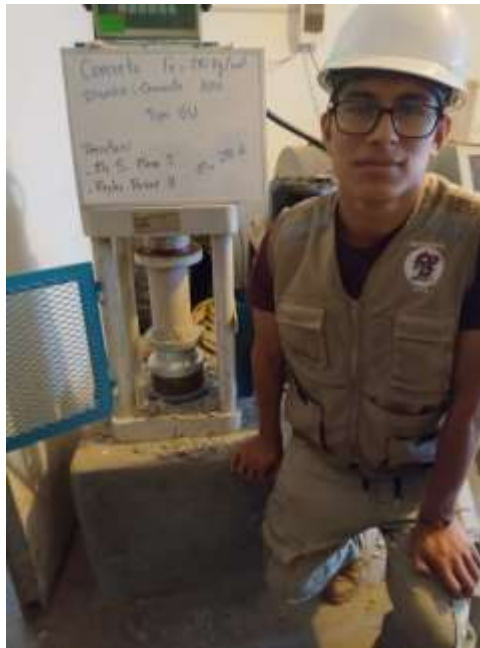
Compresión del concreto. Cemento Yunga tipo GU, e=28d
